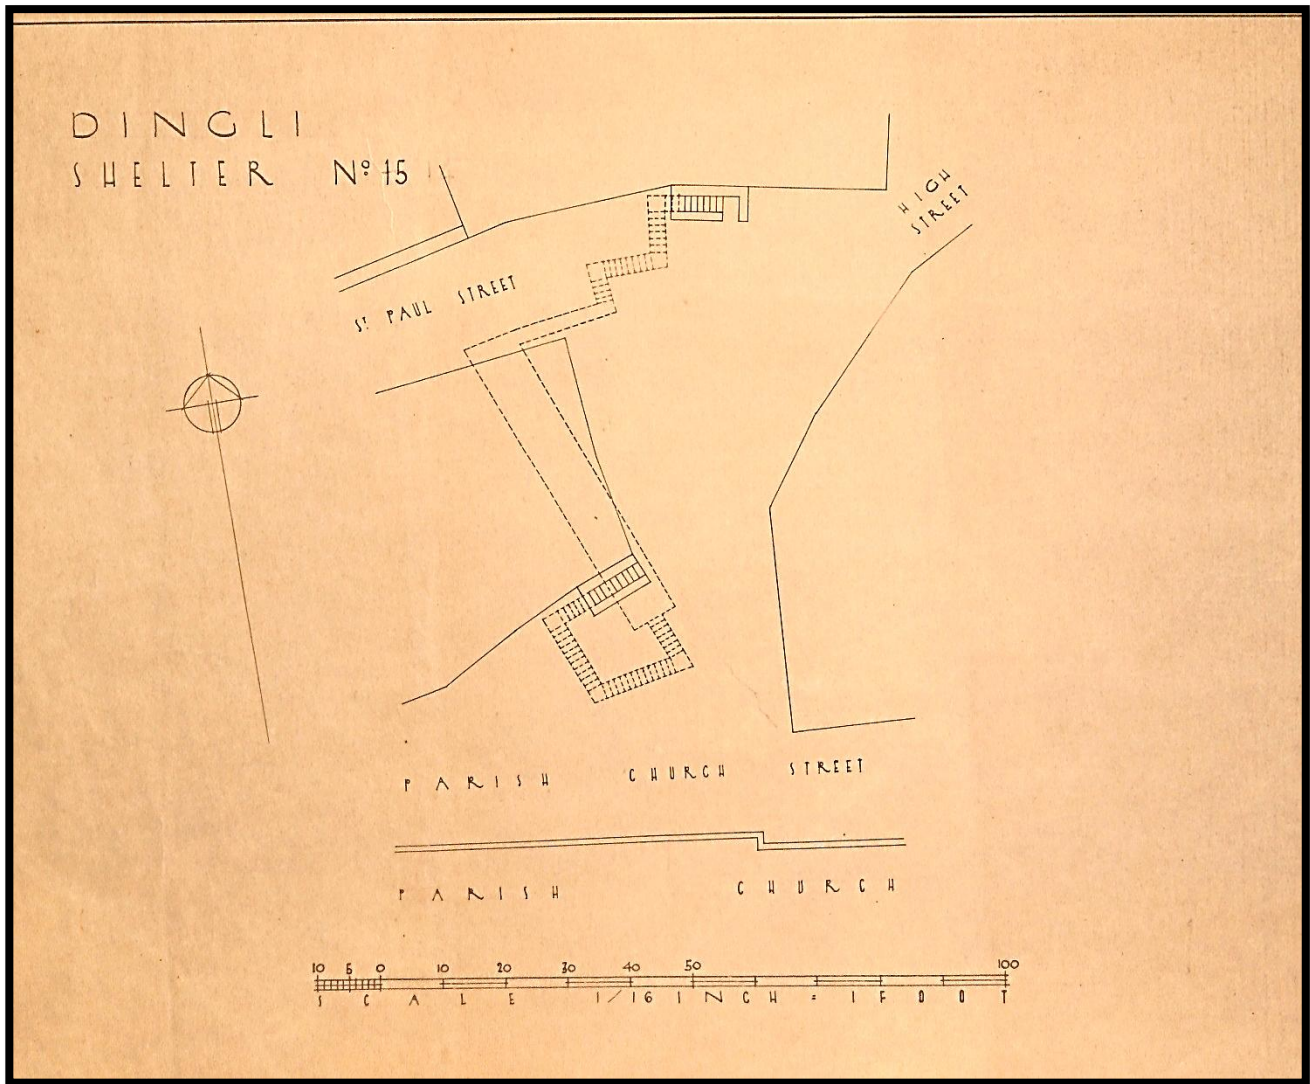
Planta do Abrigo nº15 (14) "Saint Paul Street – High Street – Parish Church Street."
